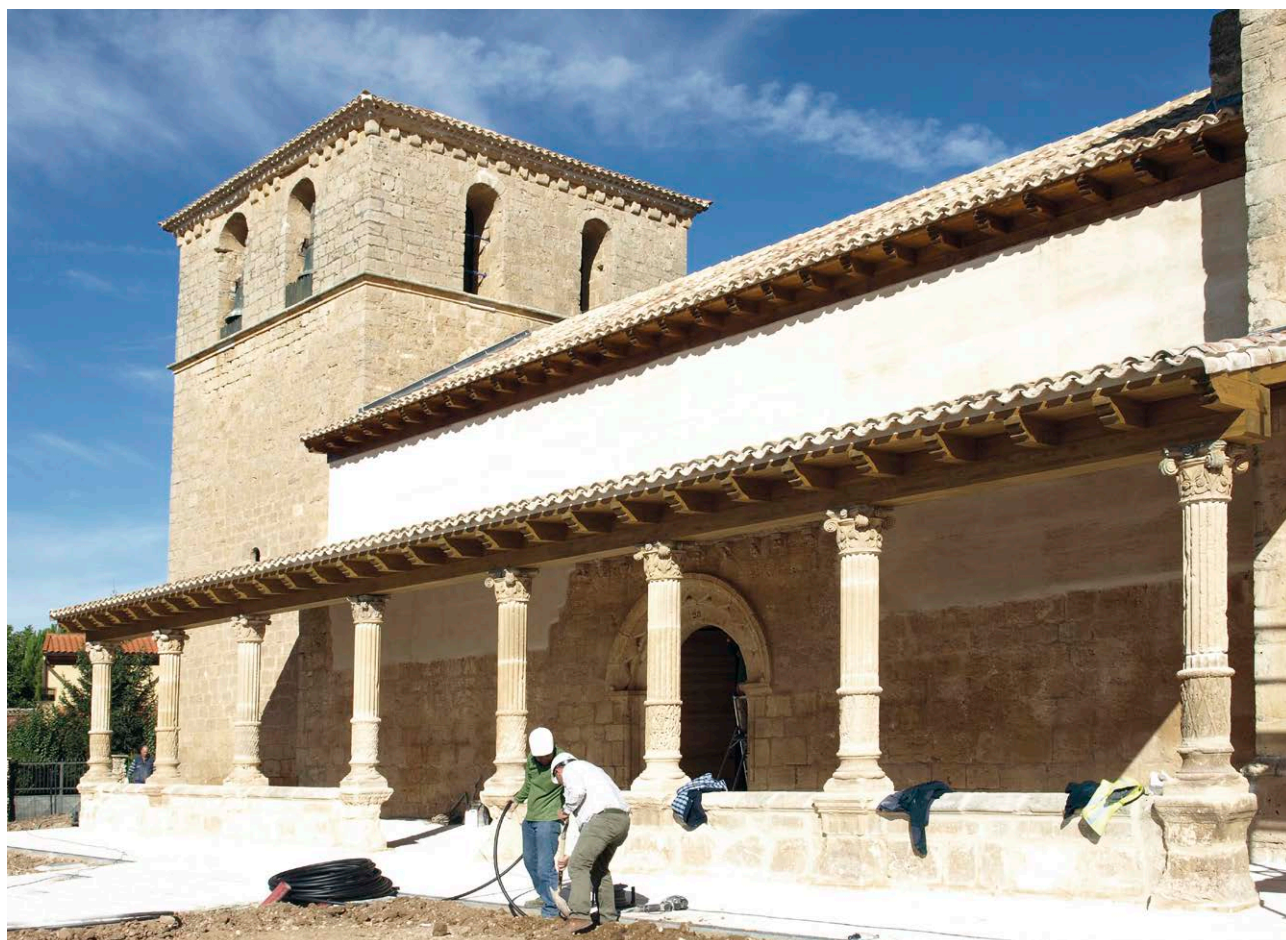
Iglesia de San Nicolás de Bari. Estado de la fachada sur de la nave después de los trabajos de restauración
